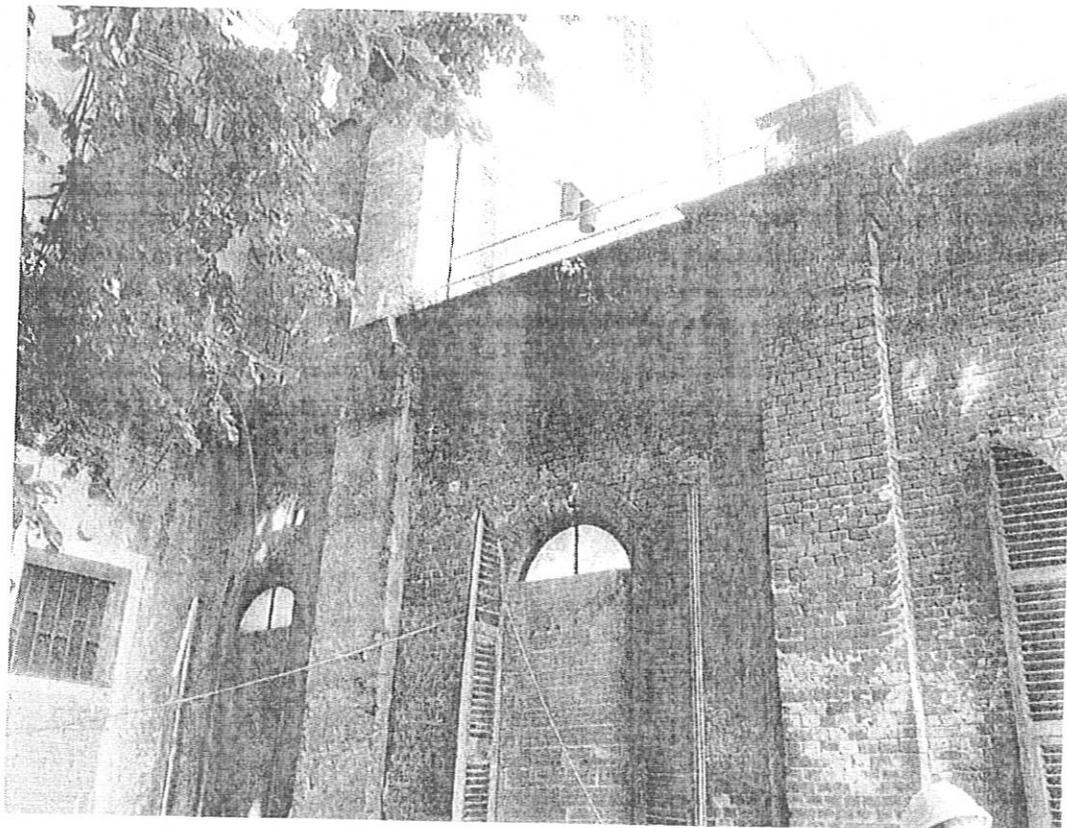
Fessura inclinata a 45° sulla parete ovest dell'avancorpo con terrazzo
